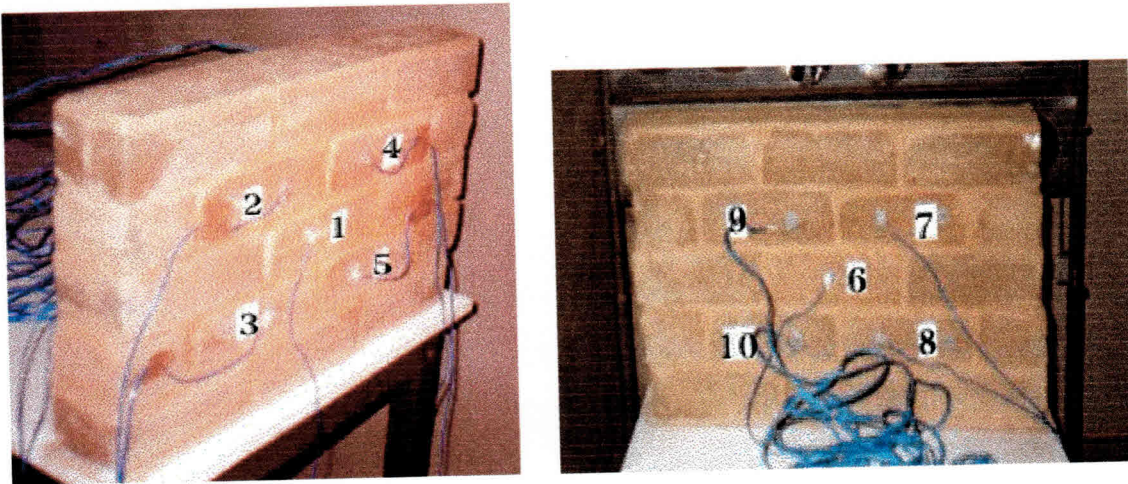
Detalhe para instrumentação do ensaio para verificação do comportamento térmico das paredes
